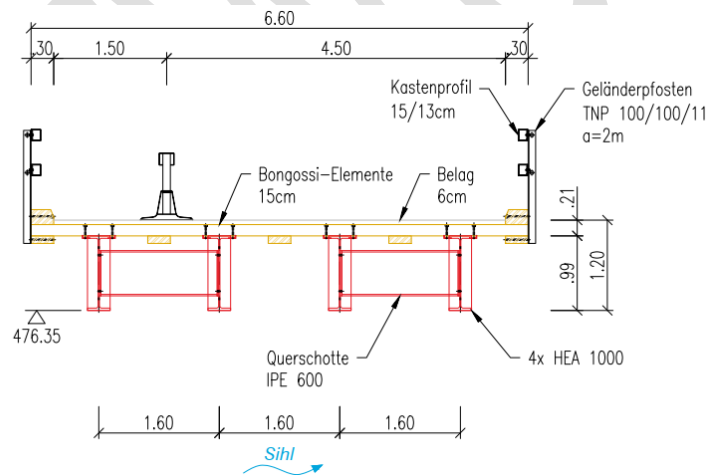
Querschnitt Brückenoberbau, Beilage 5, Stahlbauplan, van Randen-LGB AG
